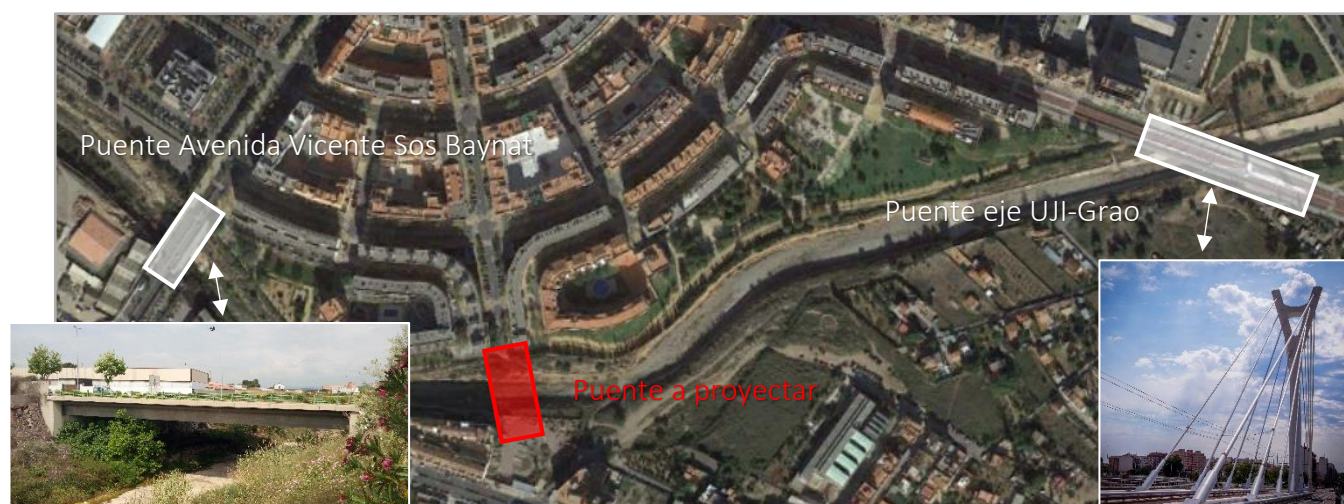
Puentes actualmente construidos sobre el Río Seco en la zona universitaria (en blanco) y puente a construir (en rojo).
